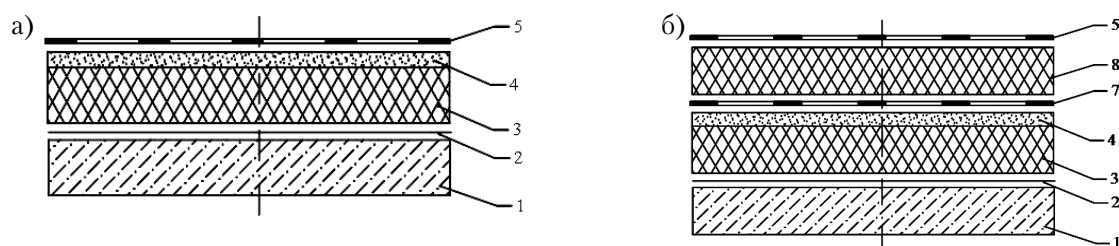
Варианты выполнения кровельных работ: а – по существующей кровле, б – с демонтажем конструкций кровельного покрытия, 1 – основание, 2 – пароизоляция, 3 – существующая теплоизоляция, 4 – стяжка, 5 – гидроизоляционный слой, 7 – существующая гидроизоляция, 8 – доутепление.
